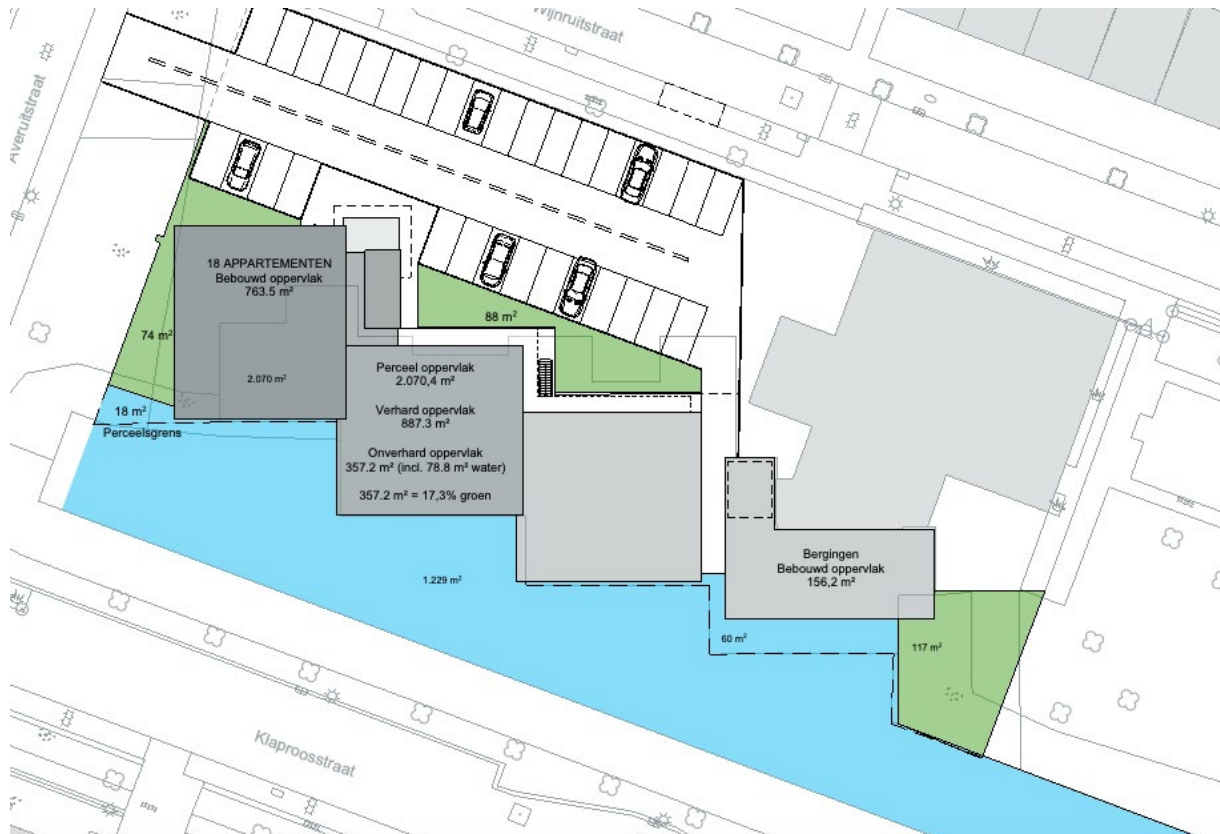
Situatietekening nieuwbouwplan Wijnruitstraat 196 te Waalwijk
